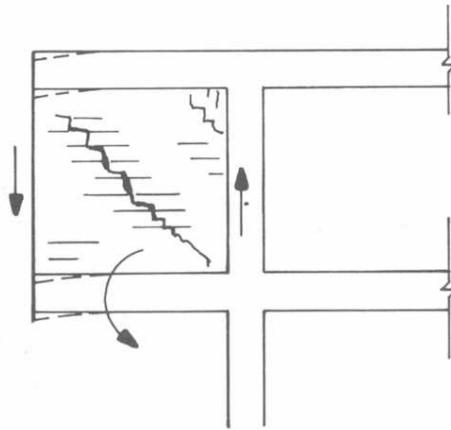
Trincas na alvenaria, provocadas por deflexão da região em balanço da viga.
